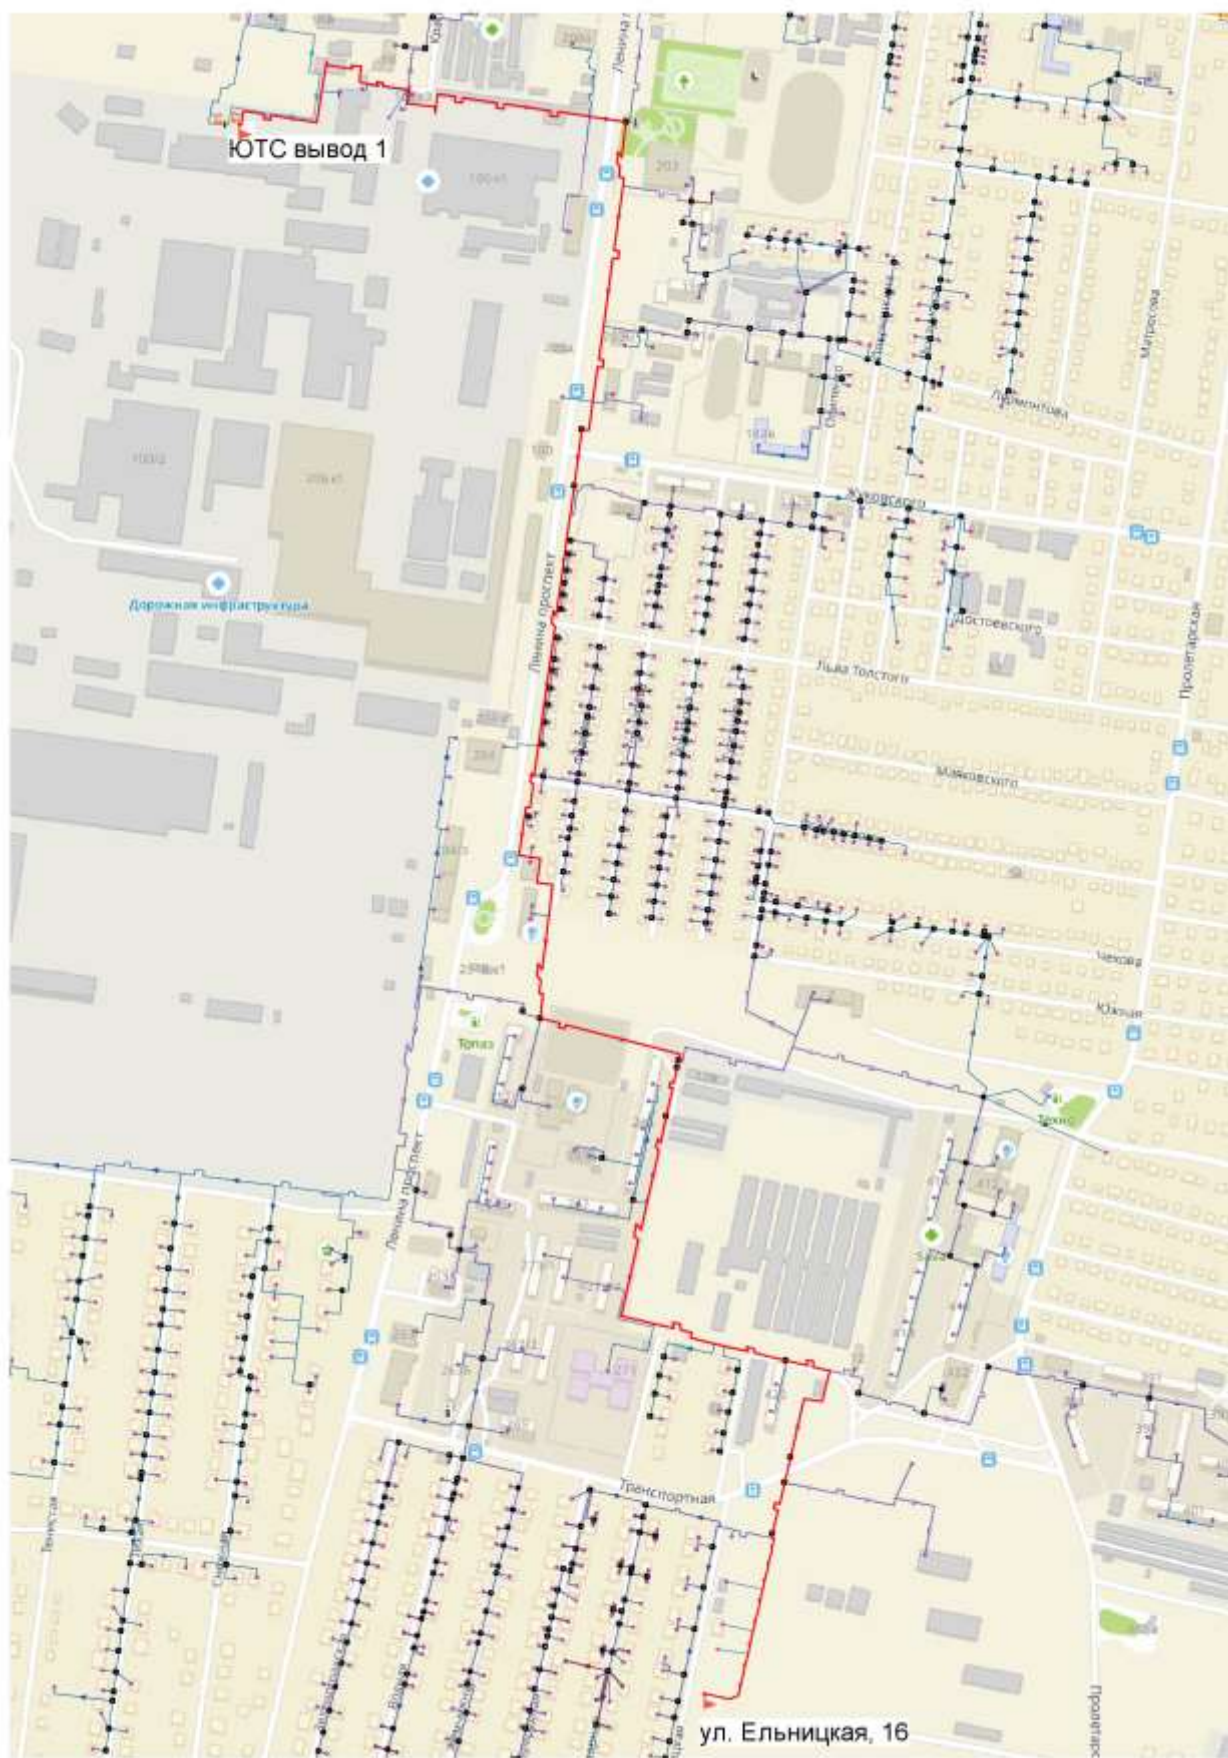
Трассировка теплопровода от ЮТС, вывод № 1 до индивидуального жилого дома по ул. Ельницкая, 16
